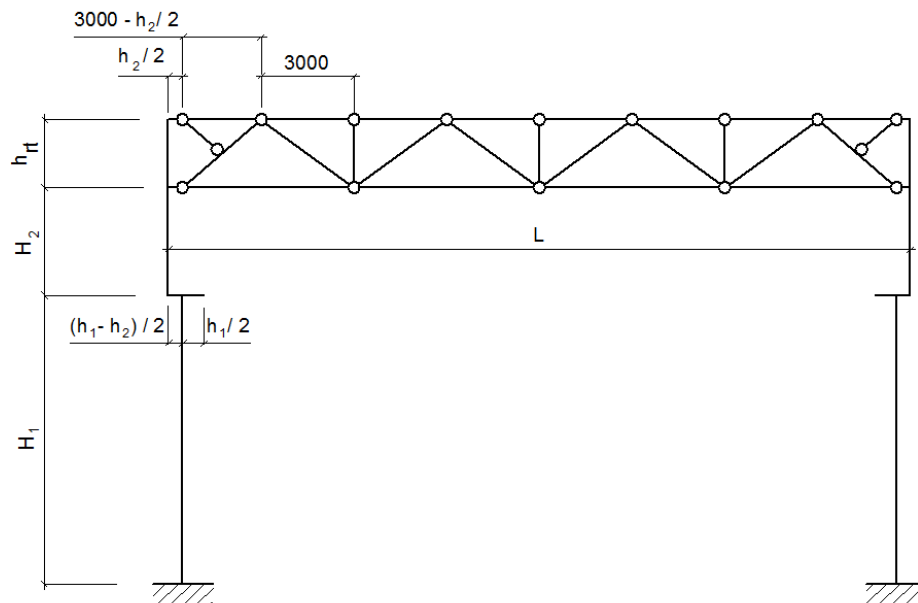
Расчетная схема рамы без фонаря с колоннами сплошного сечения.
